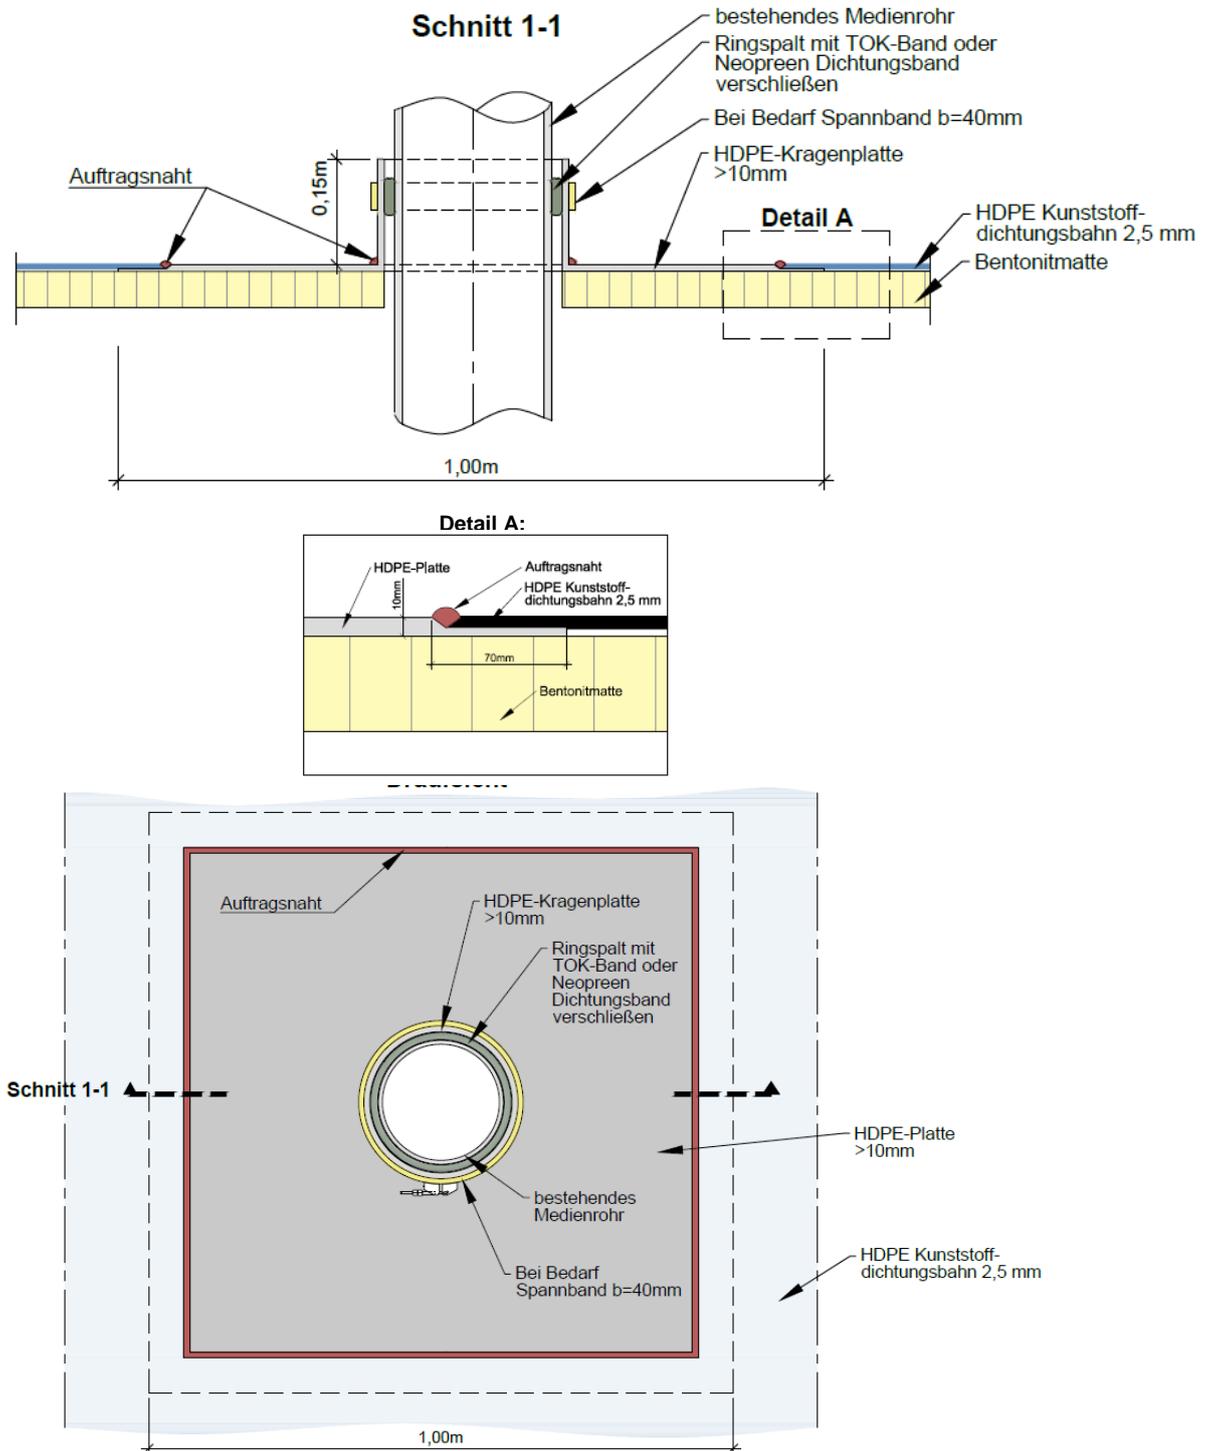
Durchdringung PVC- und Betonrohre
